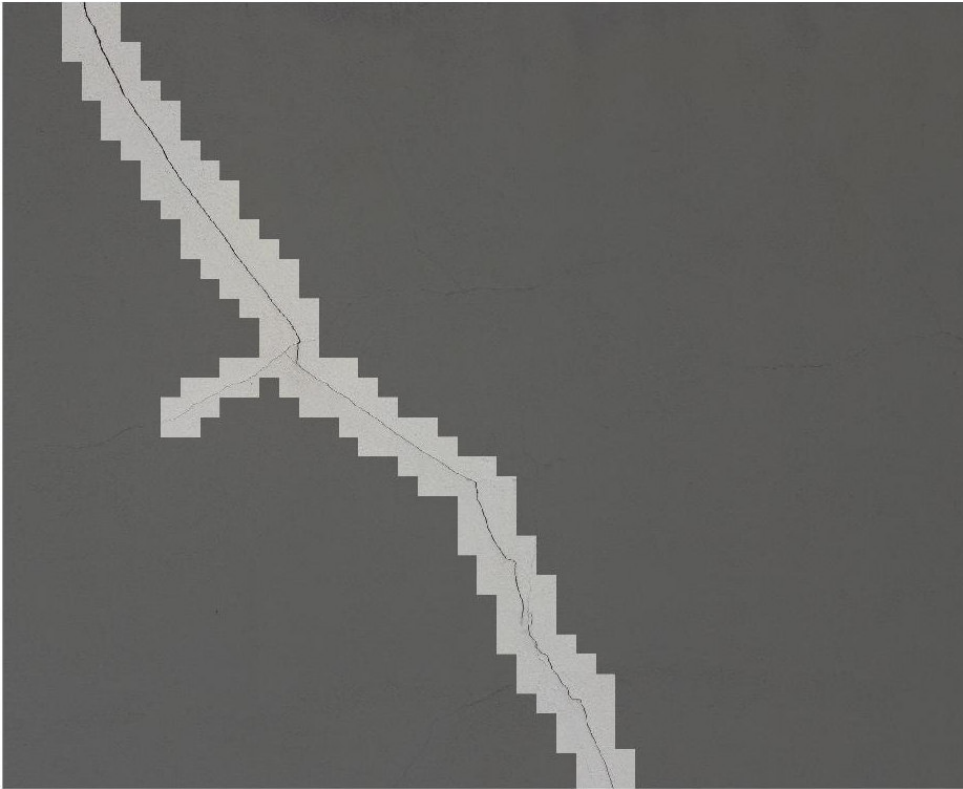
Detecção Fissura Z.F.11
